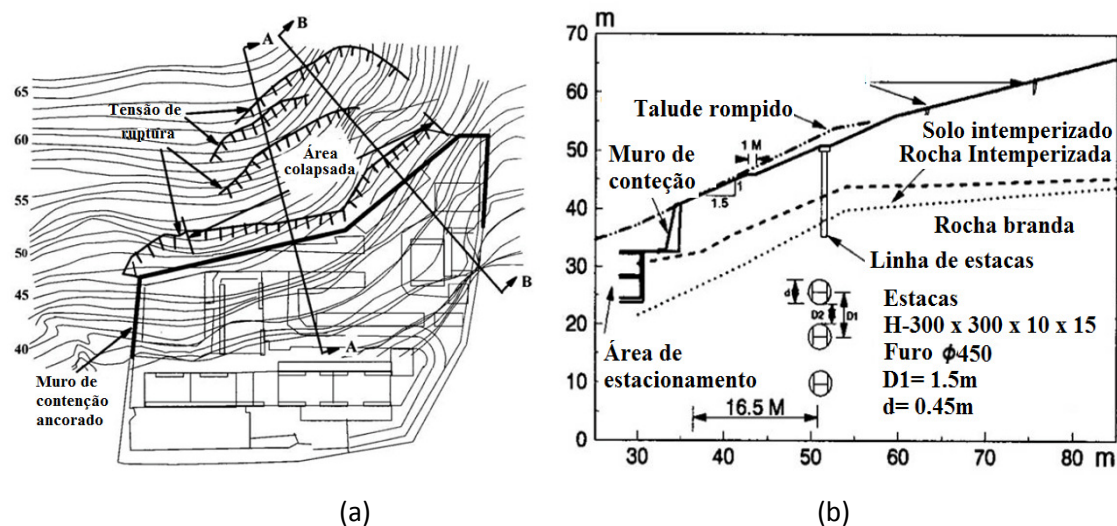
a) Planta de localização das linhas dos escorregamentos. B) Layout das contenções para estabilização do talude (Song et al., 2006).
